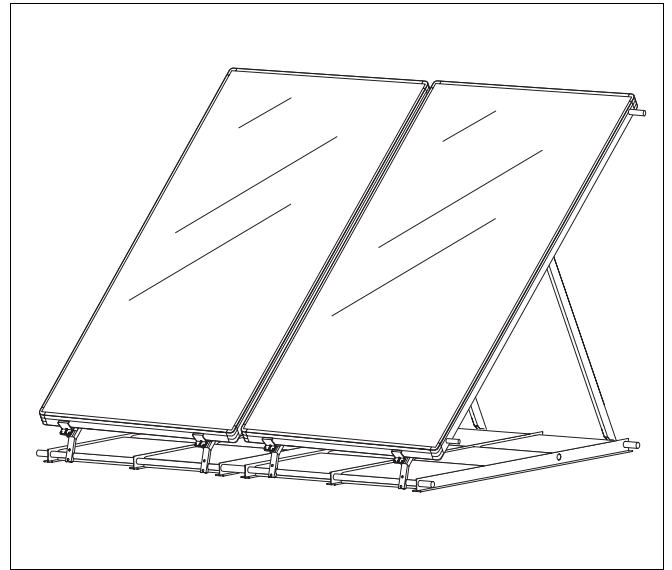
Colectores completamente montados, soportes para tejado plano, modelo vertical
